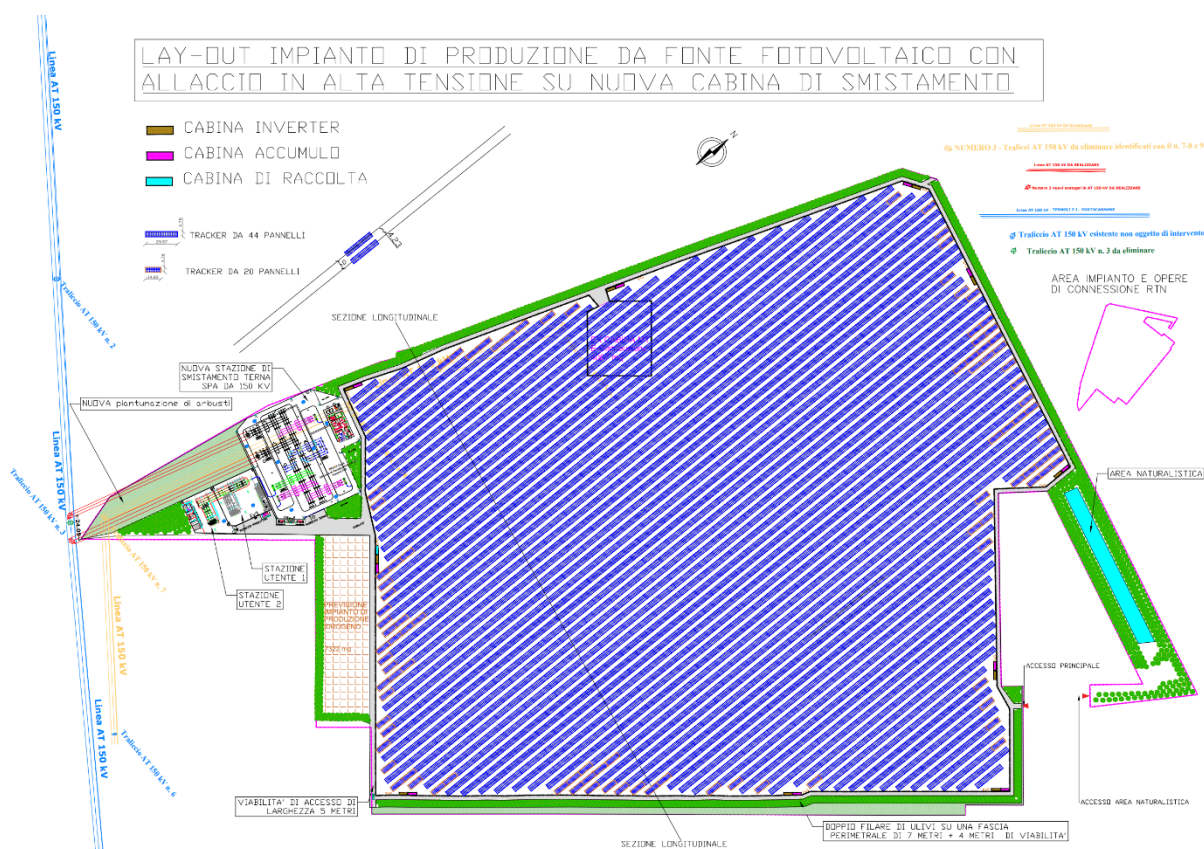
Layout dell'impianto con sistemazione delle aree a verde
